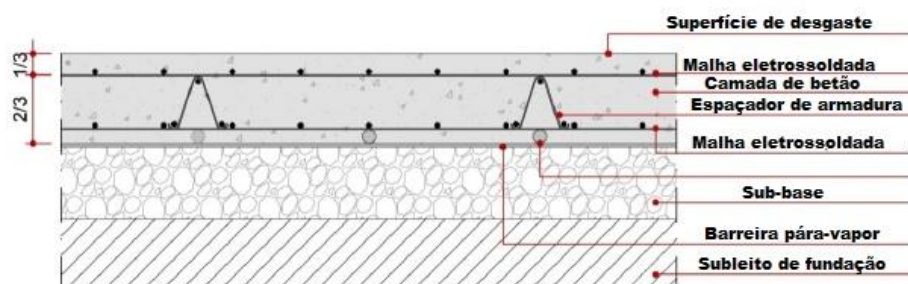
Pavimento de betão com armadura convencional/ malha eletrossoldada (malha dupla) (Adaptado de [18]).
